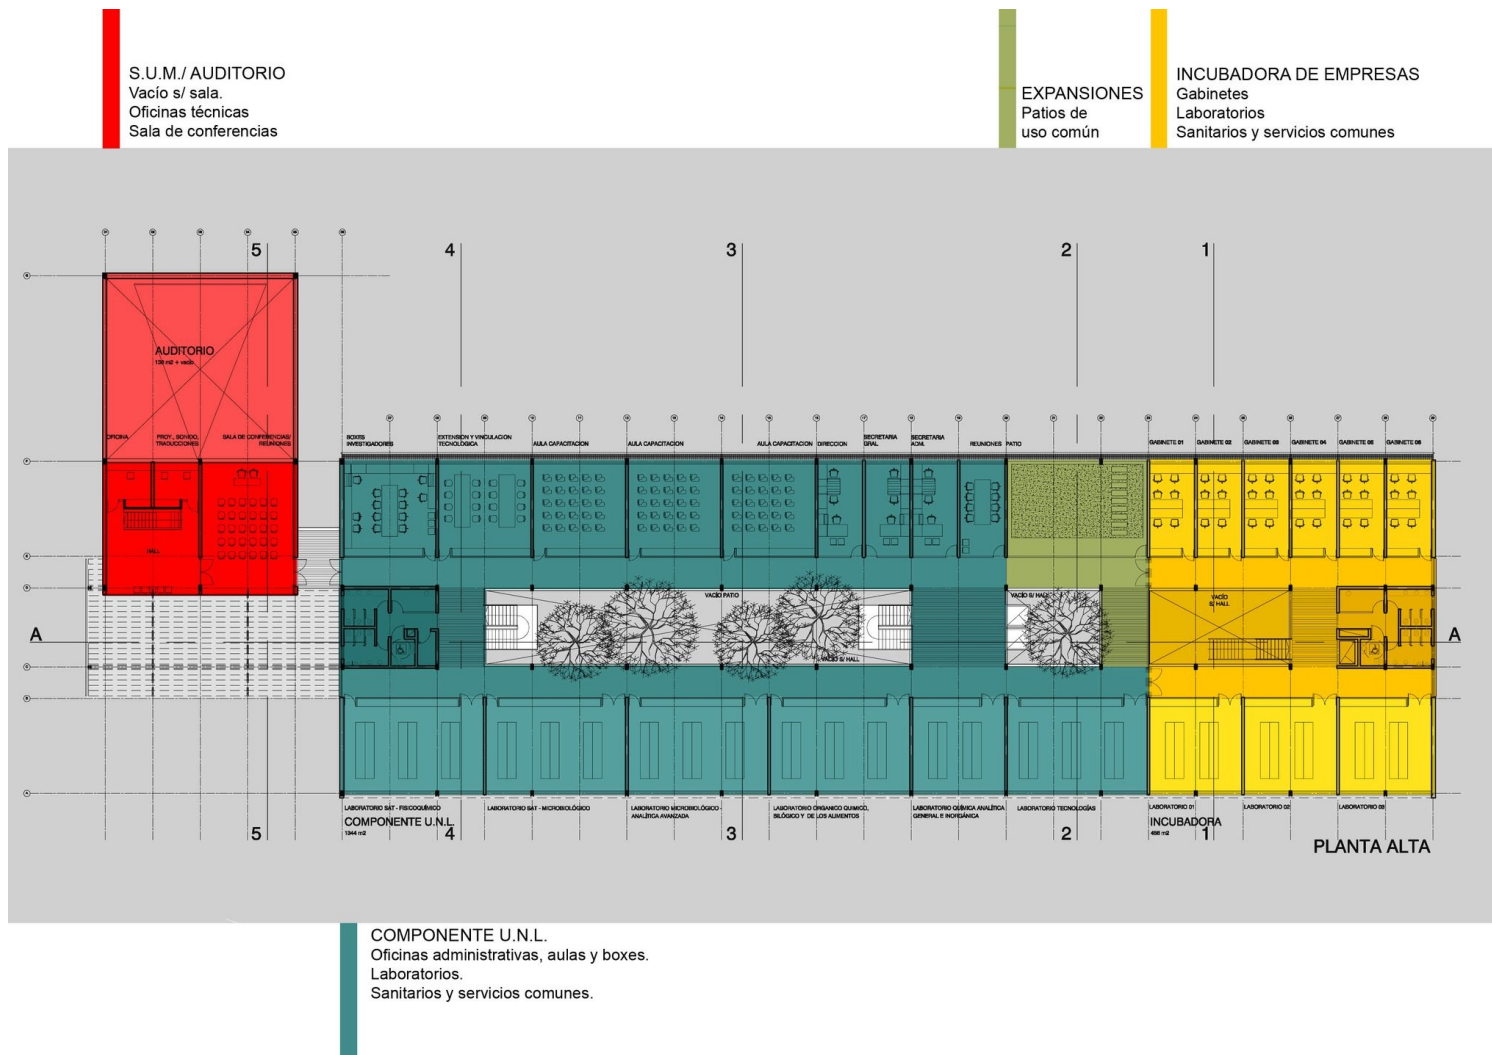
Proyecto arquitectónico – Plano de planta alta
